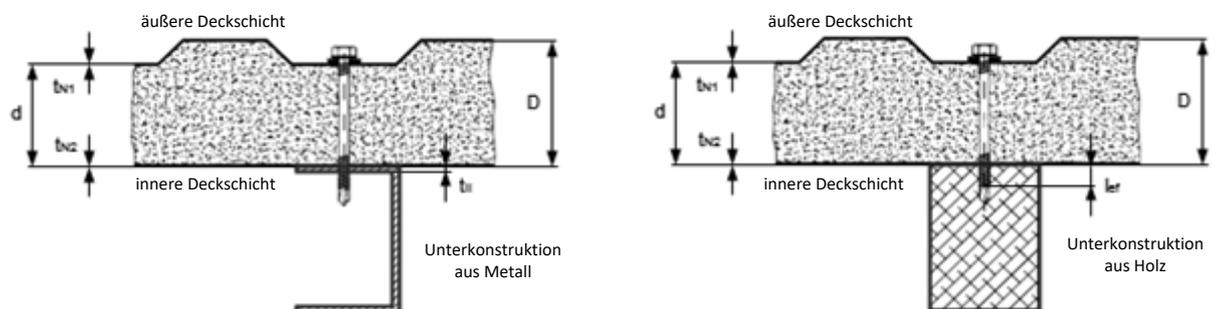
Beispiel für die Ausführung einer Verbindung (direkte Befestigung)
